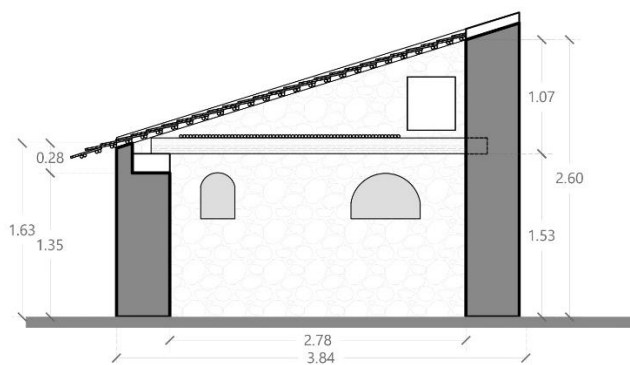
Corte transversal B-B'. Casa de Piedra, ejemplo 1. Fuente: Elaboración propia.
